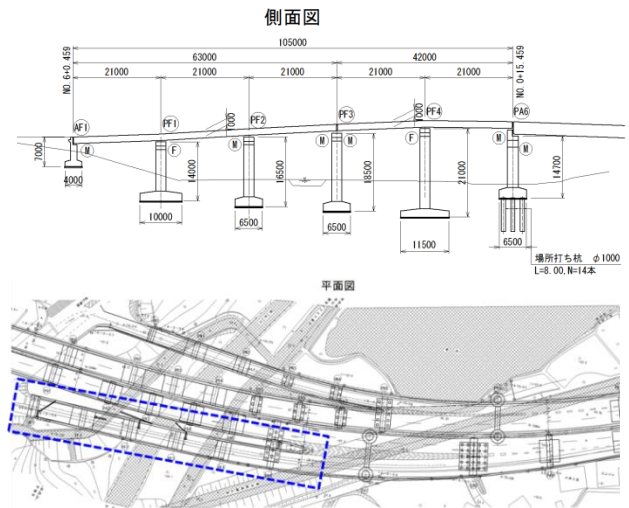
榎山高架橋 OFFランプ (側面図・平面図)
